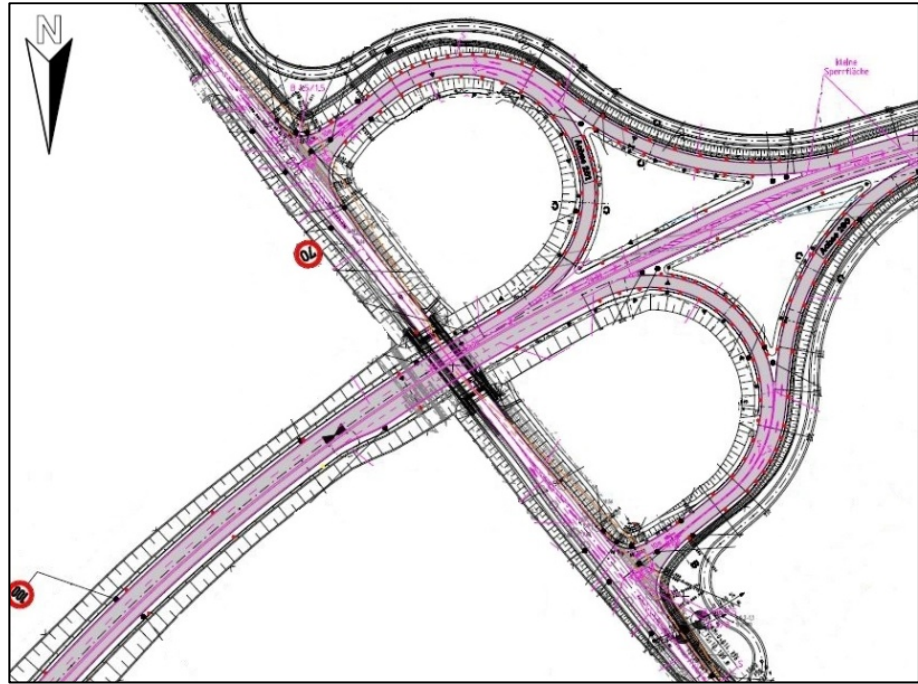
Knotenpunkt 2 AS Garz (VEAPLAN ROSTOCK GBR, 2009)
